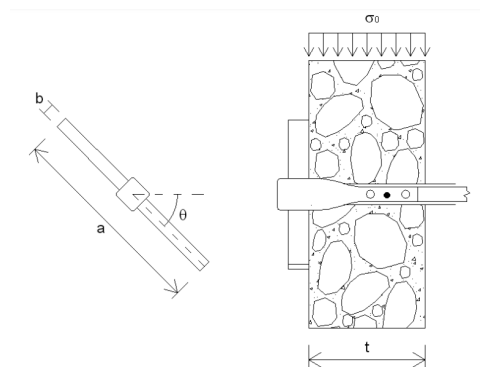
Capochiave a paletto in prospetto e sezione.
